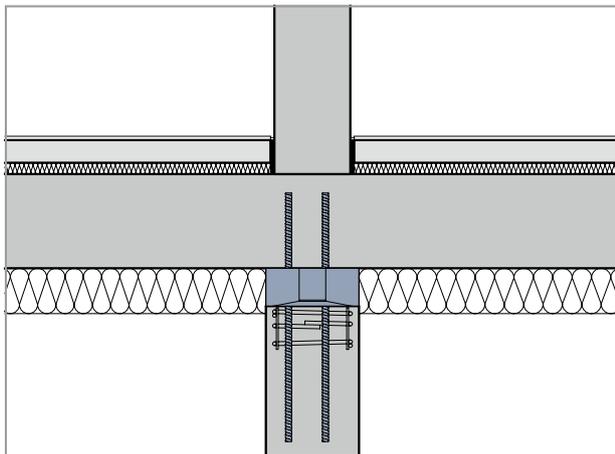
Schöck Sconnex® type P with internal columns and under-slab insulation
